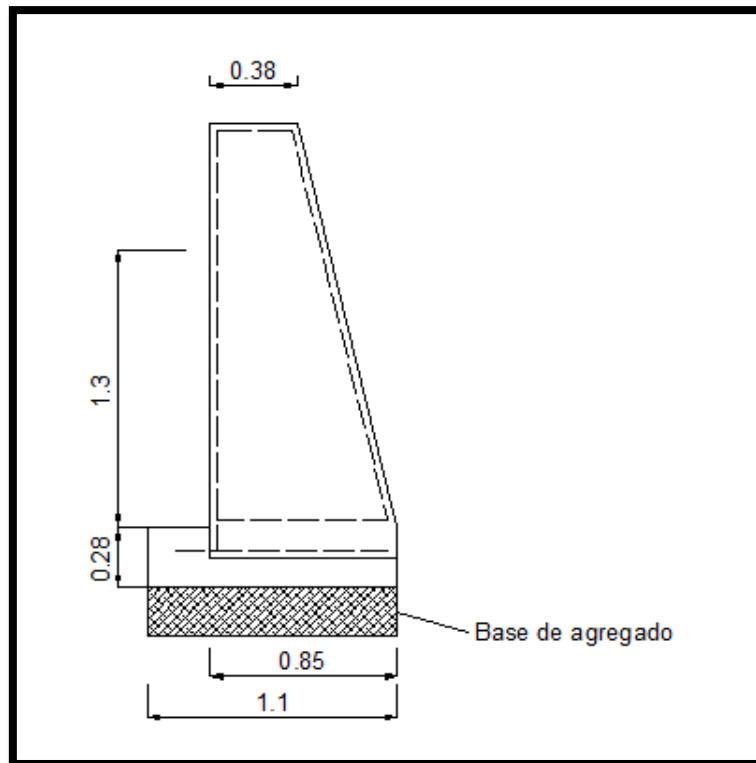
Elevación lateral de cabezal para alcantarillas de 1400mm.
